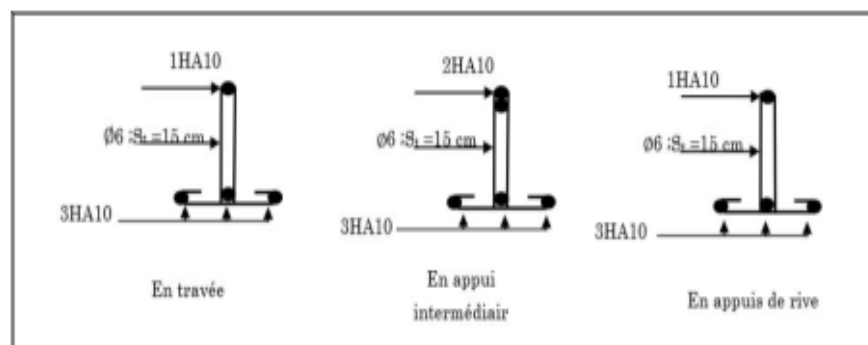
Schéma de ferrailage des poutrelles à corps creux.
